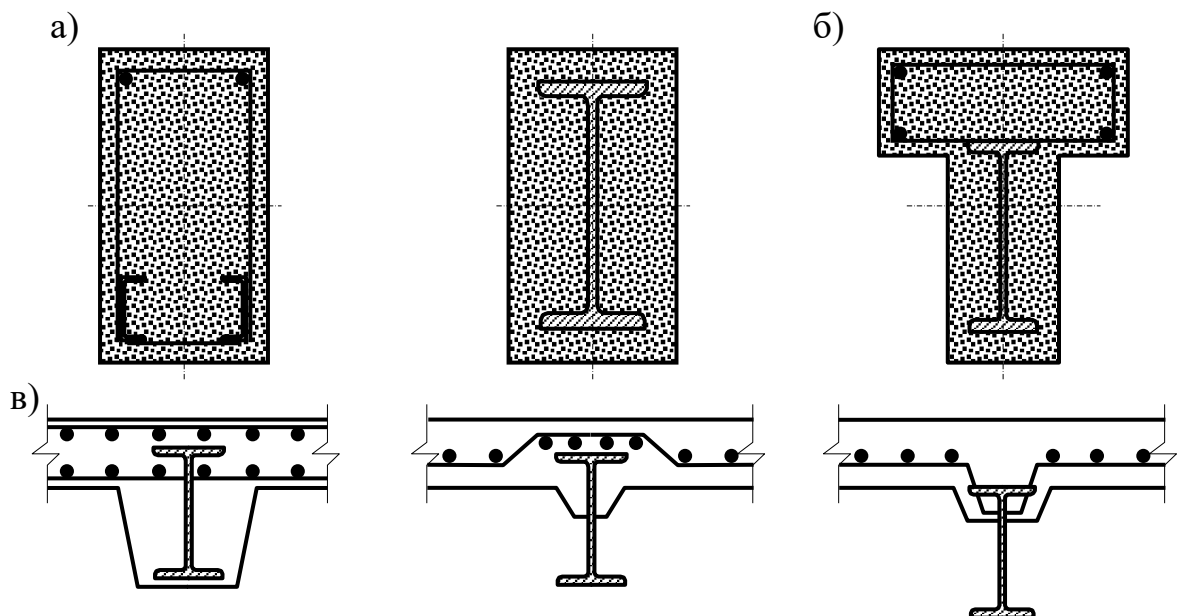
Види конструкцій сталезалізобетонних балок: а) монолітні залізобетонні ригелі; б) сталезалізобетонні балки; в) сталезалізобетонні балки в складі монолітного ребристого залізобетонного перекриття
